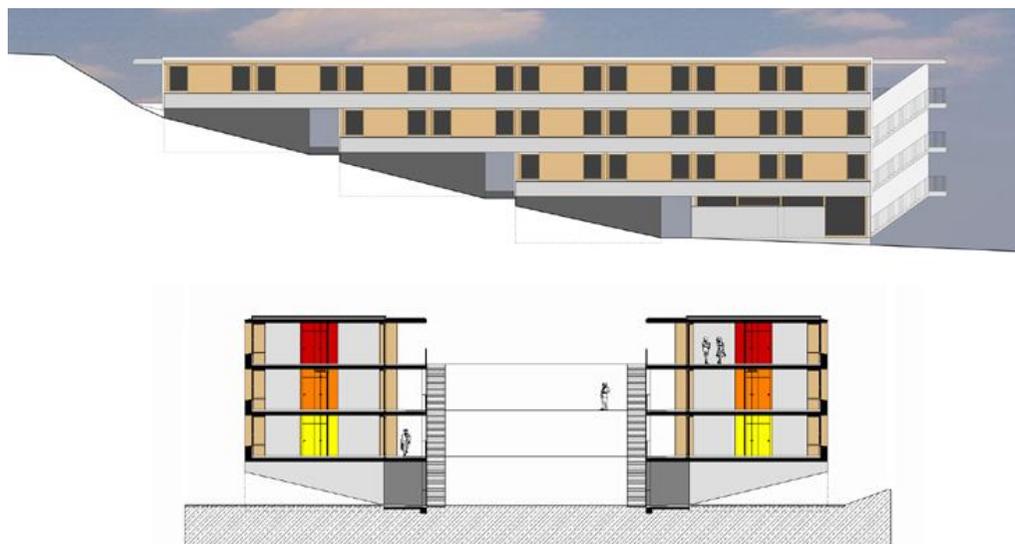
Casa Dell Accademia, fachada/corte e perspectiva
